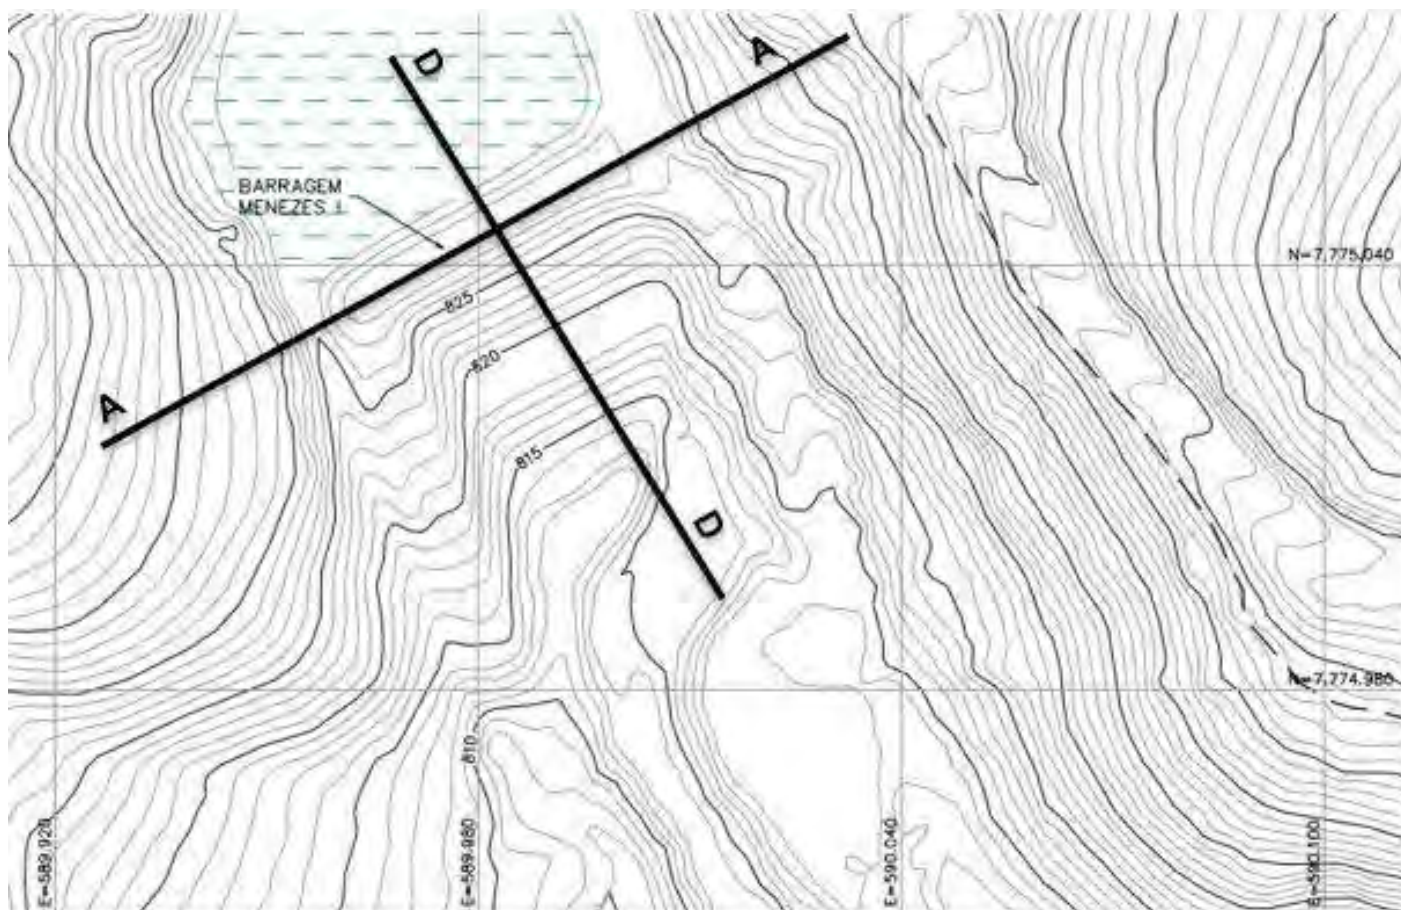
Planta de localização das seções para análises de estabilidade.
